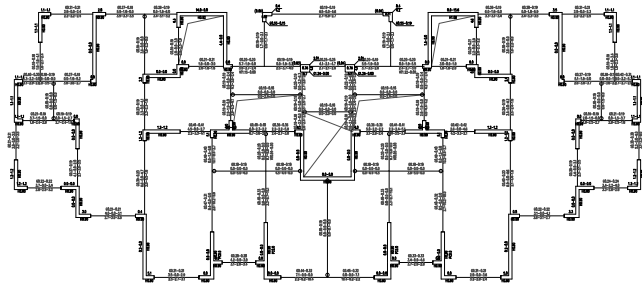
某办公楼 裙7层 标准层结构图 地上标准层结构平面布置图(单位:mm)
